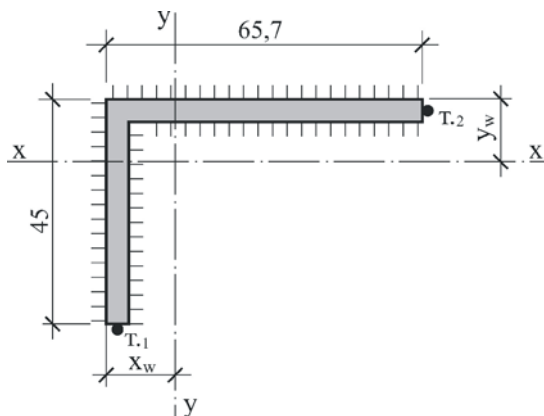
Схема сварного соединения раскоса 21 с поясом фермы
